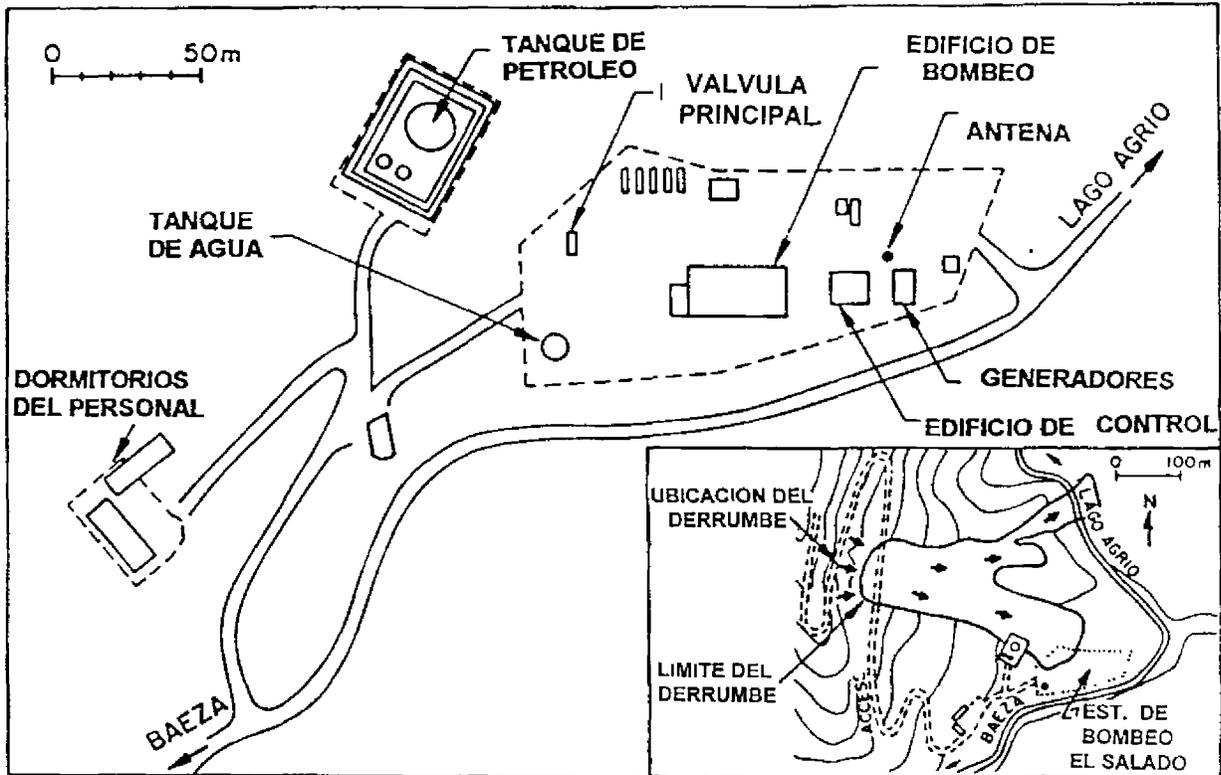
Vista en planta de la estación de bombeo de El Salado.
